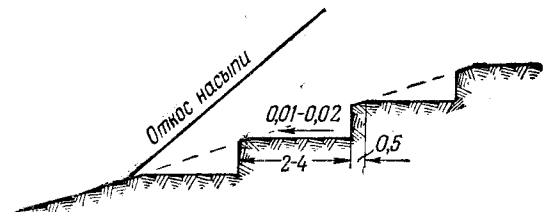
Подготовка основания насыпей на устойчивых косогорах при крутизне основания насыпи от 1:5 до 1:3
